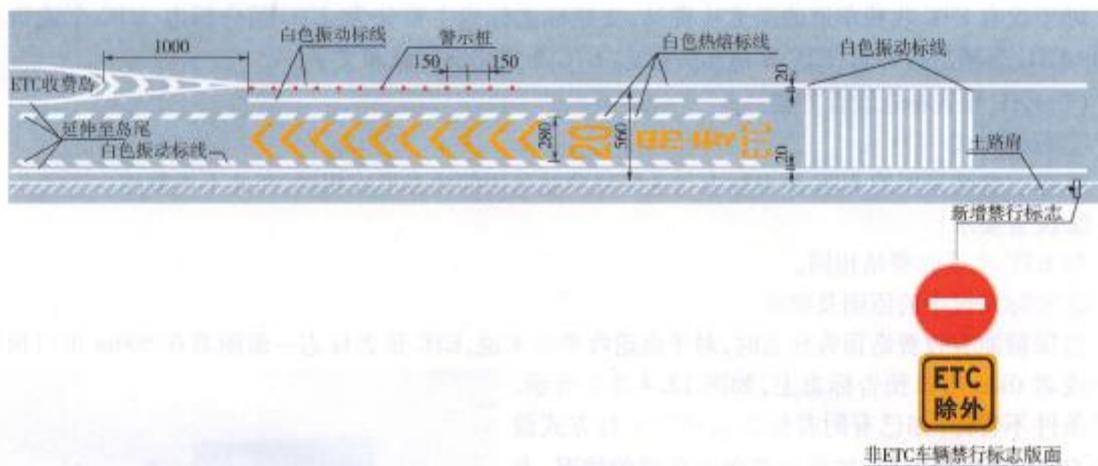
非 ETC 车辆禁令标志布置图(尺寸单位:cm)
